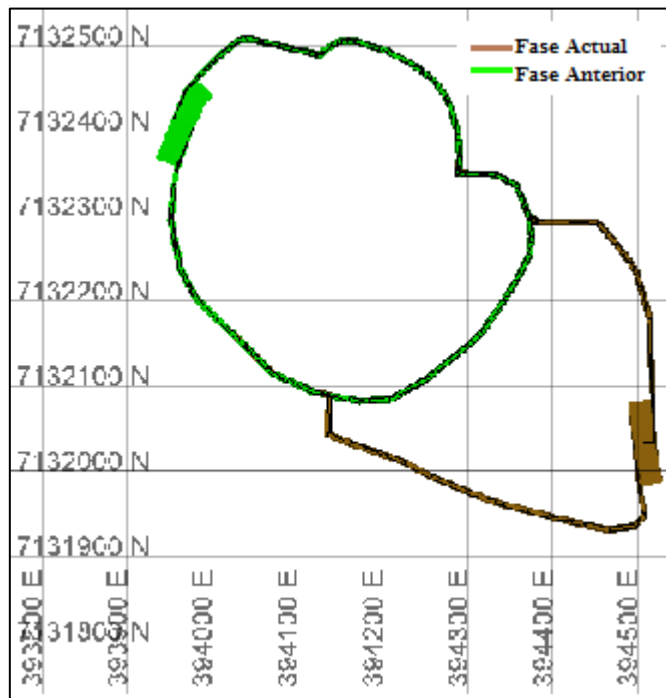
LGMM2Y Fase 3 - Vista en sección - Planta banco 1060
